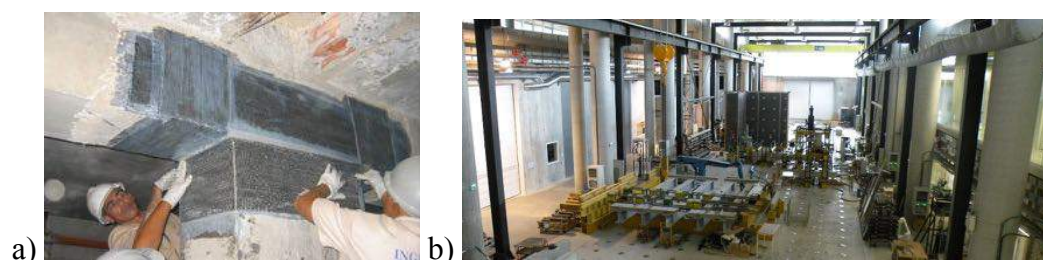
a) Exemple de renforcement de jonction b) plateforme d'essai des structures de l'Ifsttar
